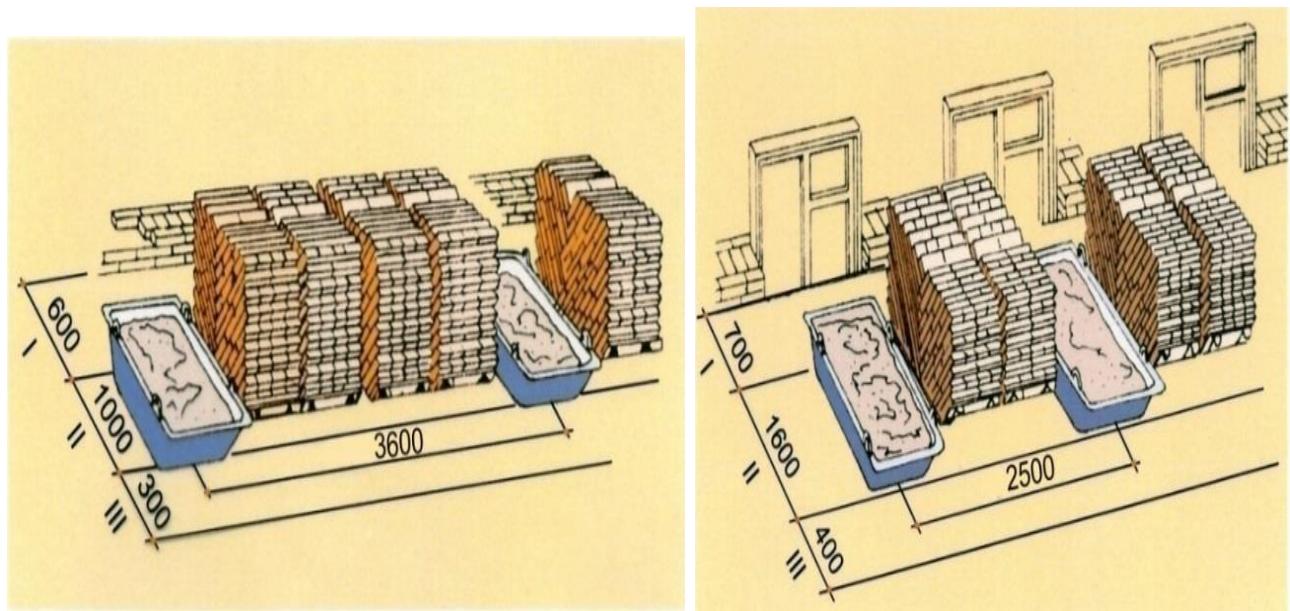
Организация рабочих мест при каменной кладке: а - глухих стен; б - стен с проемами
